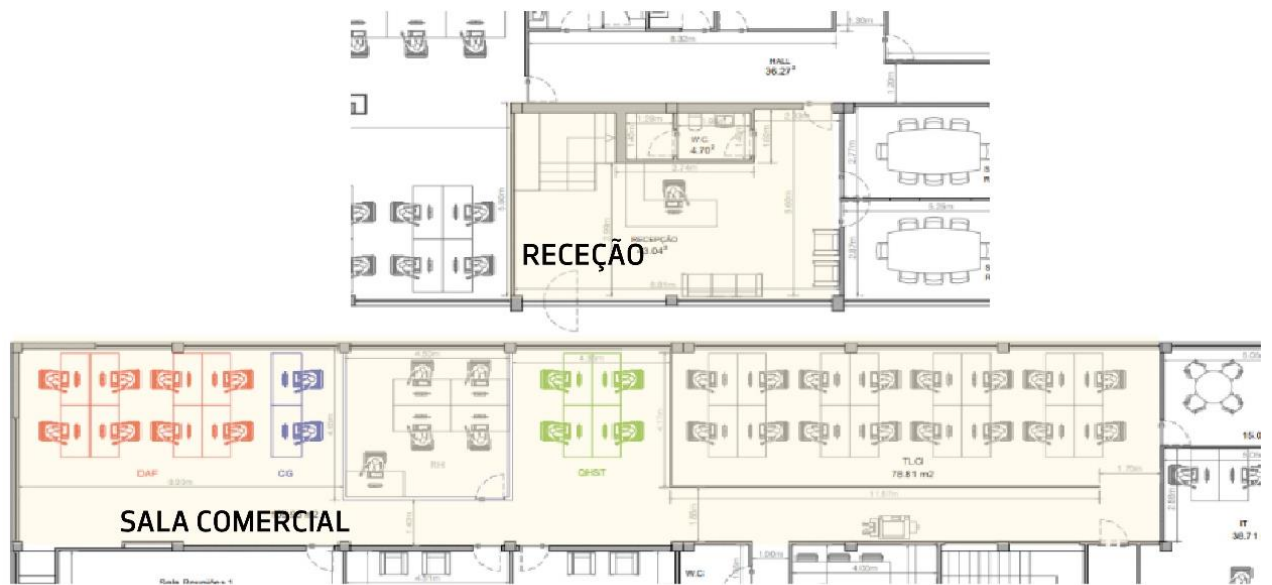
Planta da empresa TLCI. Fonte: Autor.
